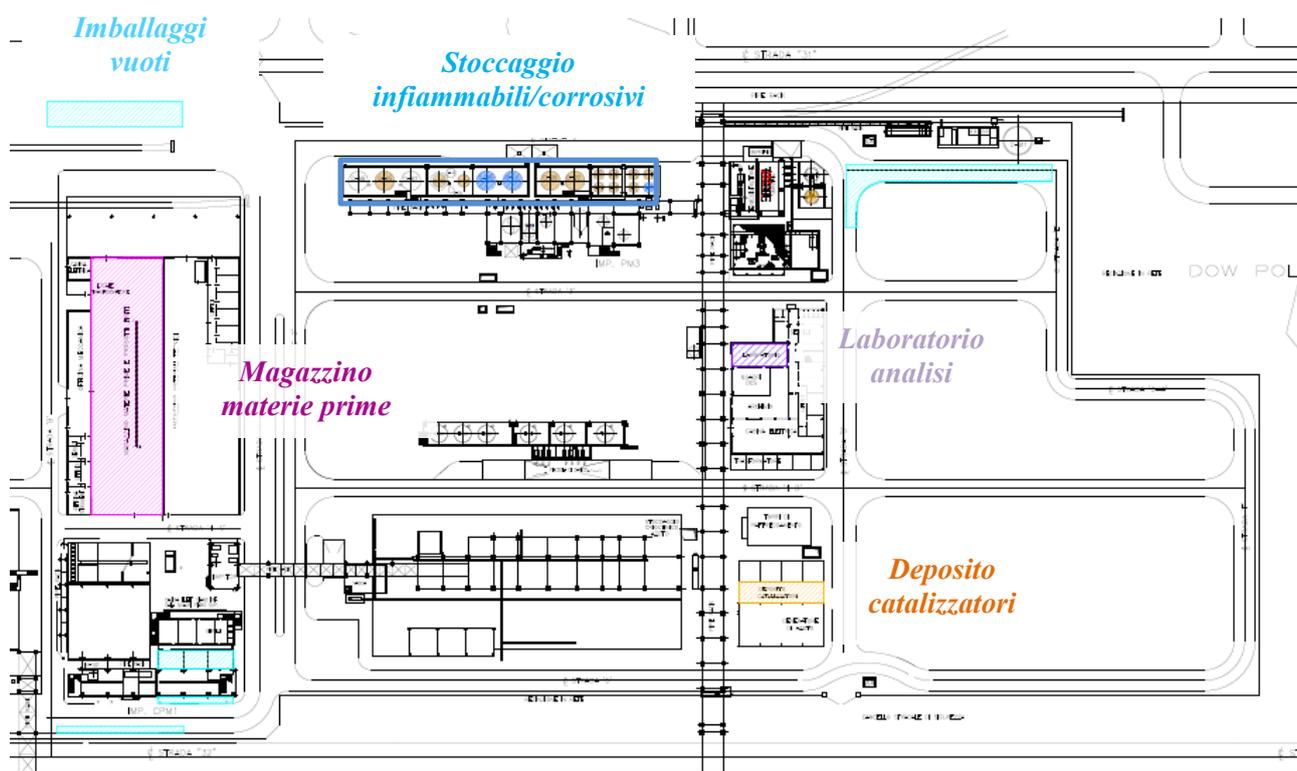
Stralcio “Planimetria area stoccaggio materie prime/prodotti intermedi” All. B22b
